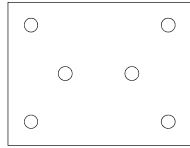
Panneaux 431 IESE, ECOROCK et ISOVER TF de dimensions 1200 x 600 mm - plans de chevillage en plein et en joint (espacement entre chevilles \geq 250 mm)
